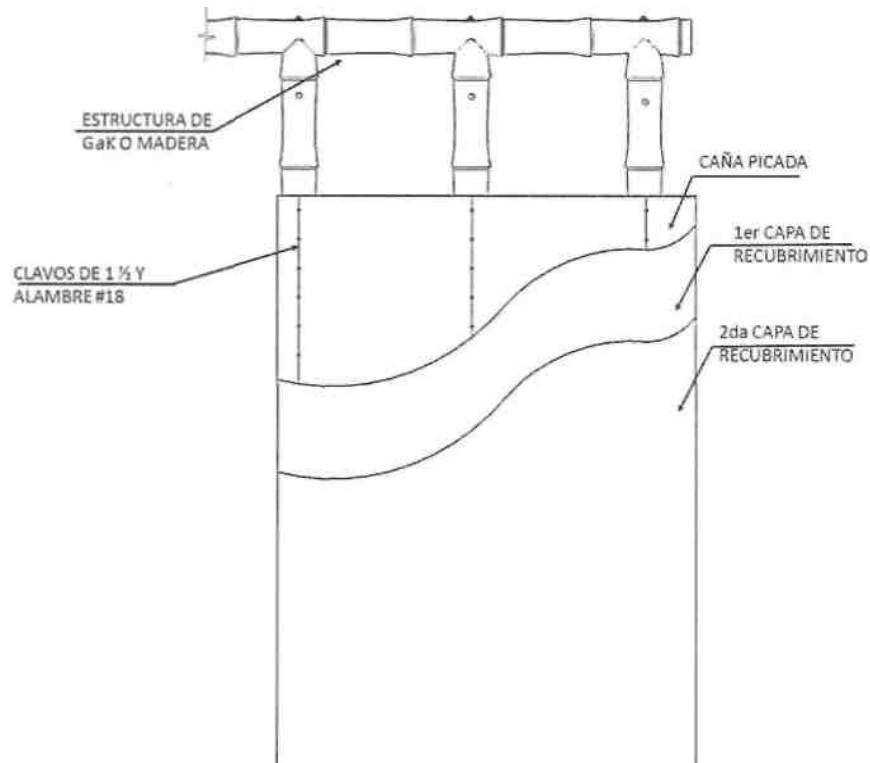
Recubrimiento de paredes con mortero de arena cemento
